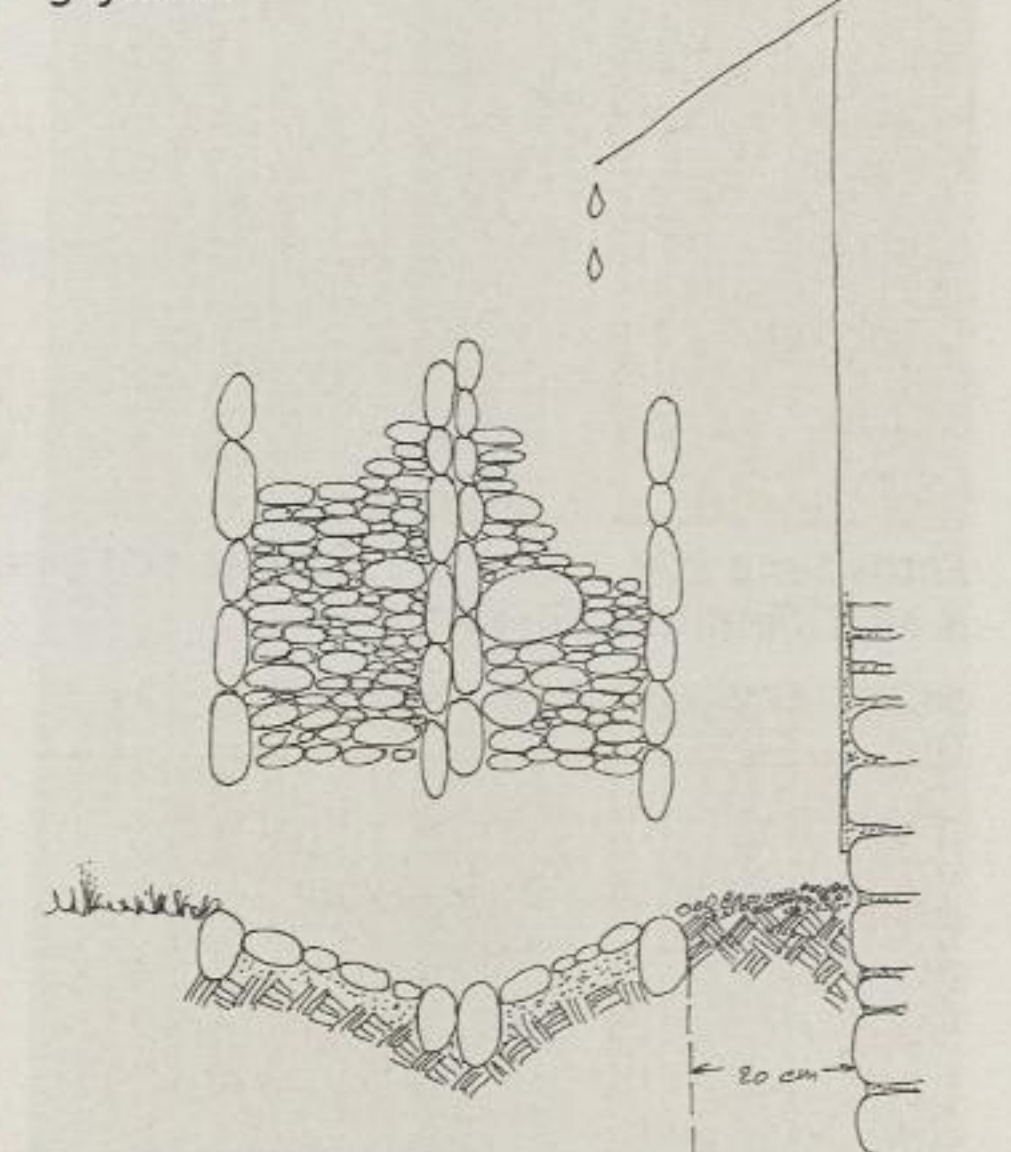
Geländeschnitt und Verlegeplan für einen Gehweg mit Drainagerinne
